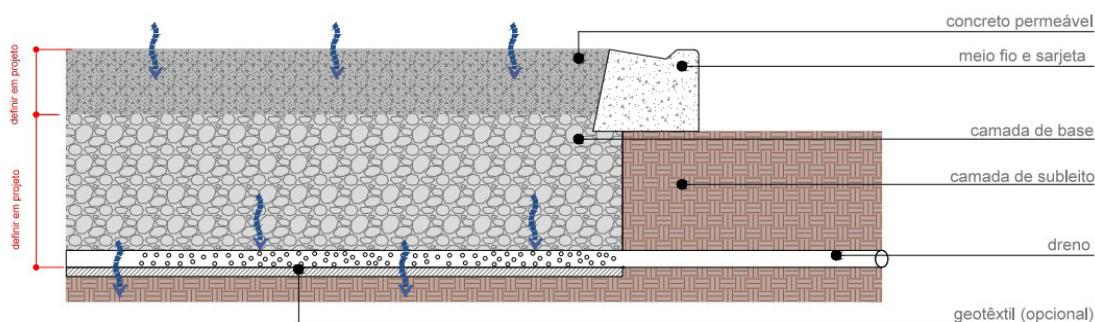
Pavimento permeável com infiltração parcial ao solo
